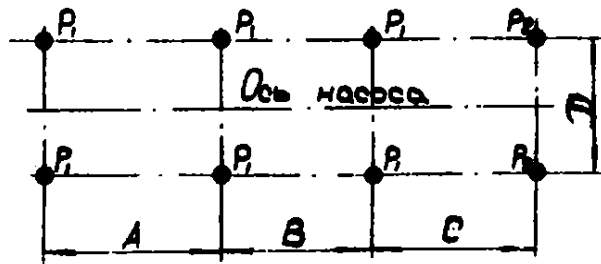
Схема распределения нагрузки на опоры от насосов типа IO ГРУ-8Т, 12ГРУЛ-12
